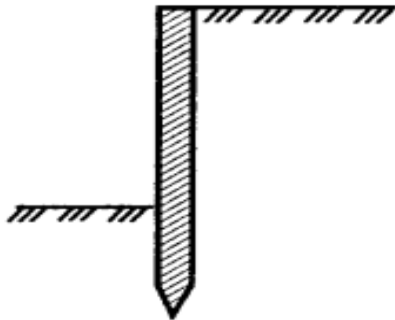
Підпiрні стiни на пал'овому фундаментi
